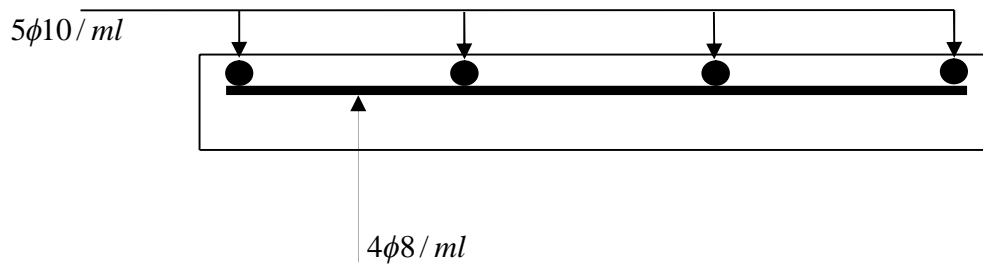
Schéma de ferrailage de la dalle pleine type 3
